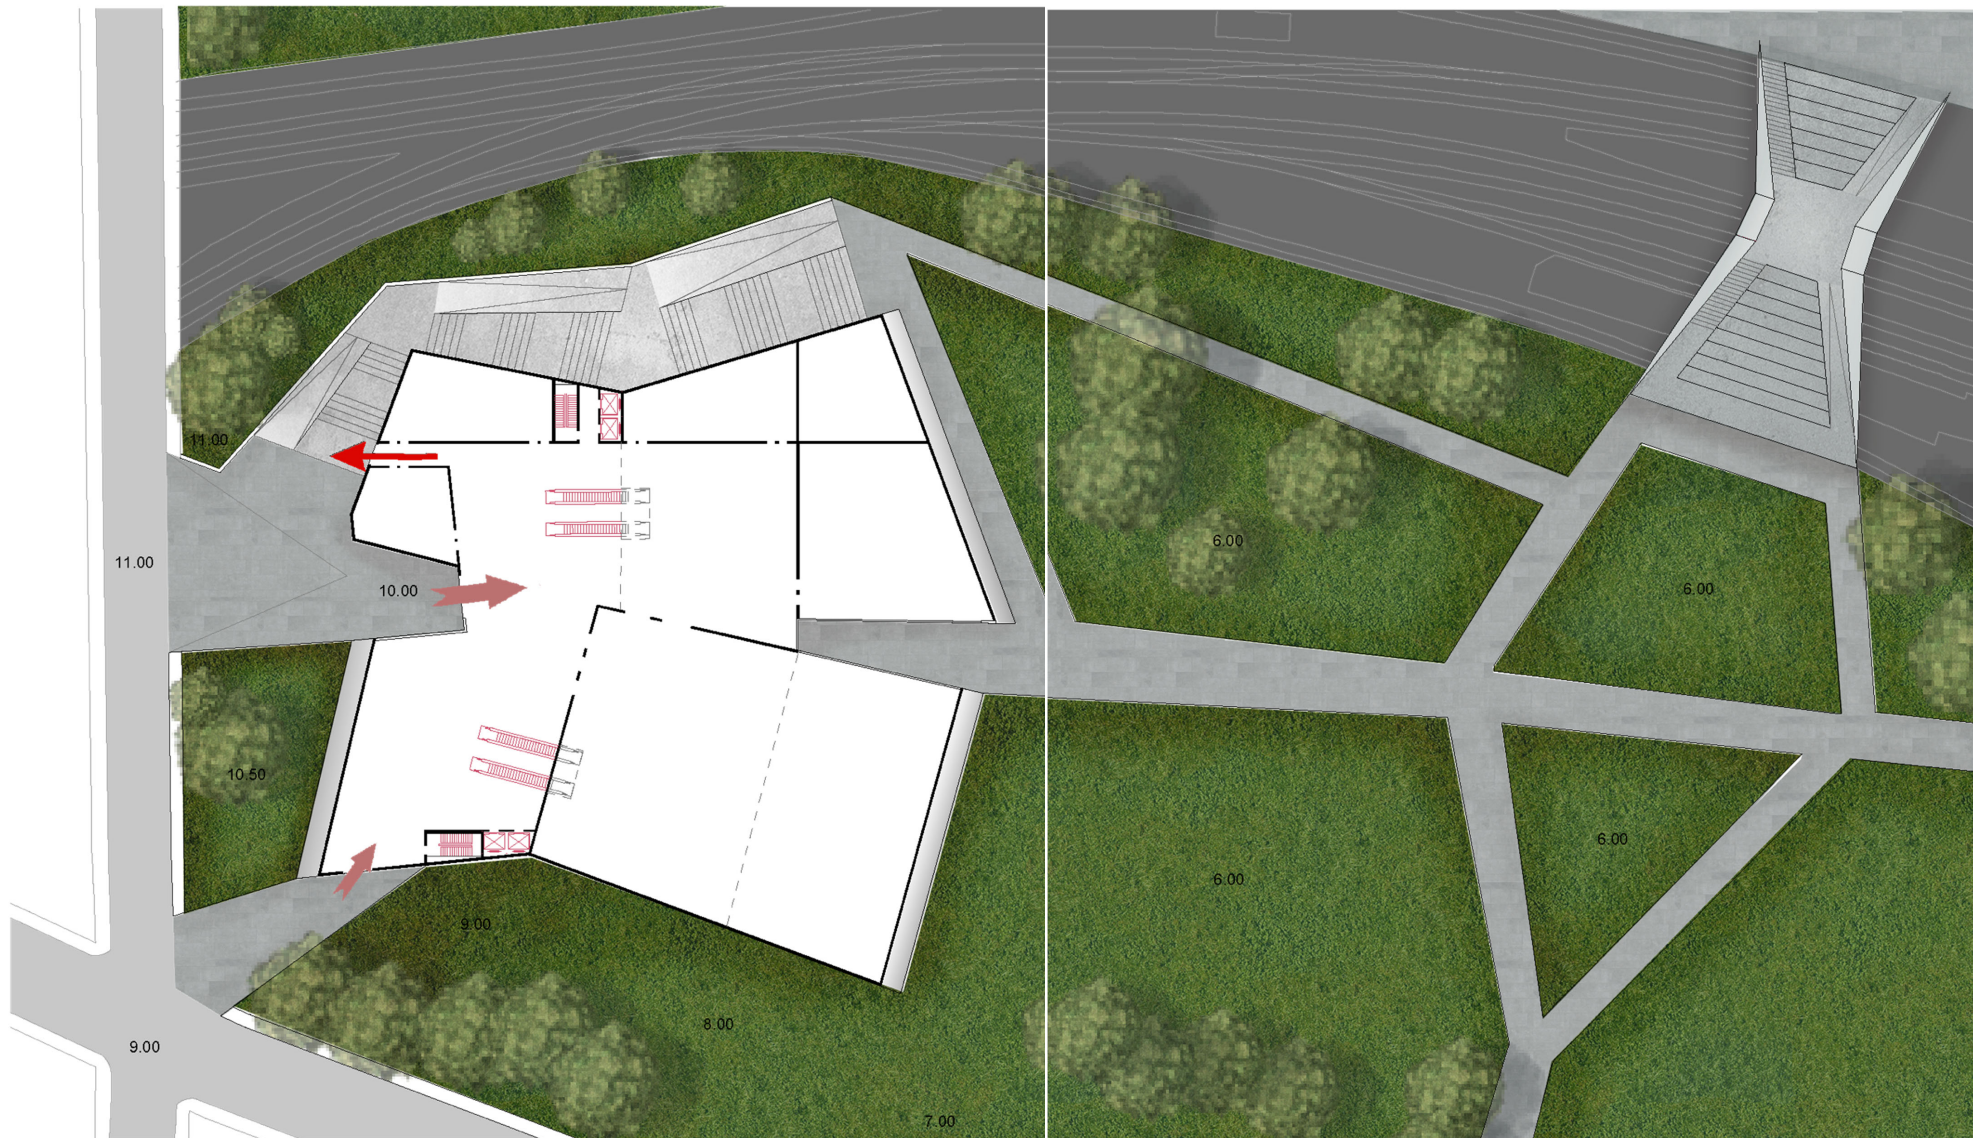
proposta de implantação e acessibilidades. Fonte: Autora
